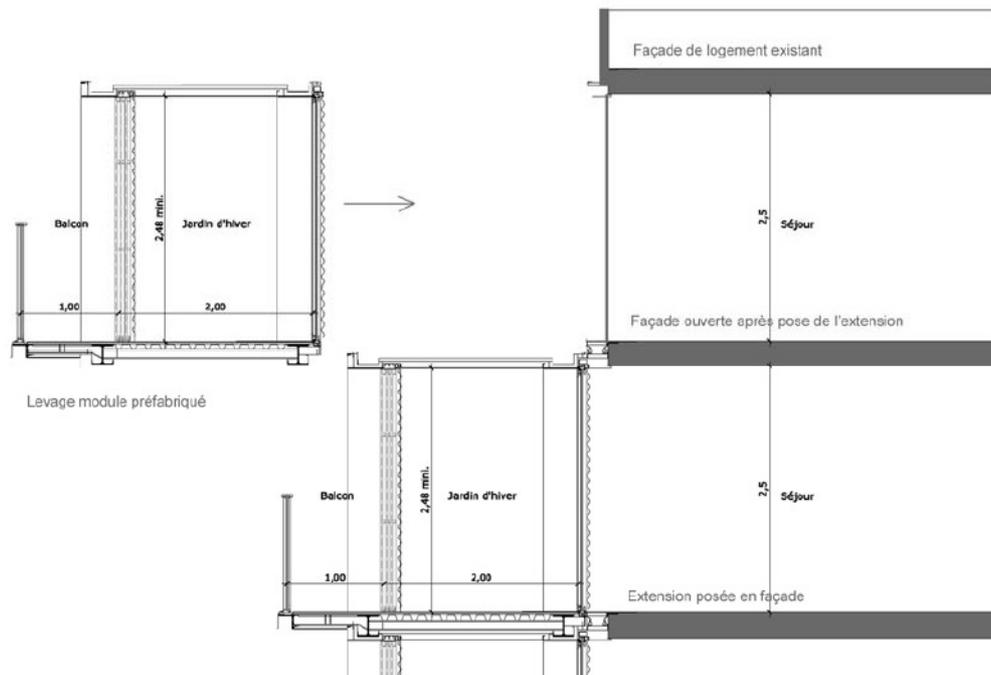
Corte construtivo | Pormenor do sistema de encaixe das extensões
